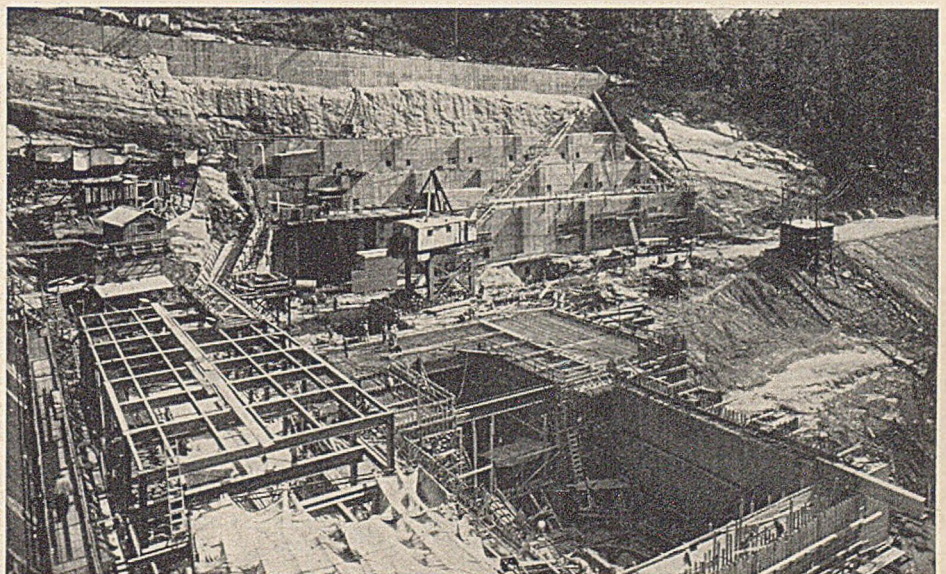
Hiwassee Talsperre. Blick in die Baugrube des Maschinenhauses.
